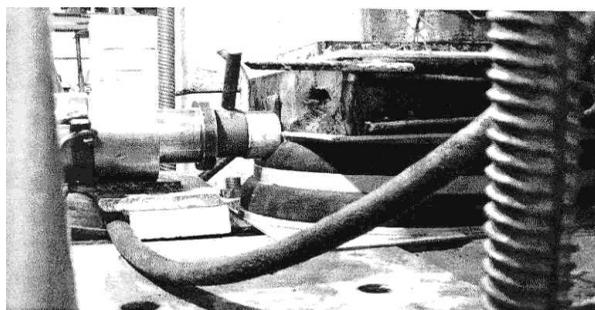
Испытания РСБ на сдвиг на специальном стенде
